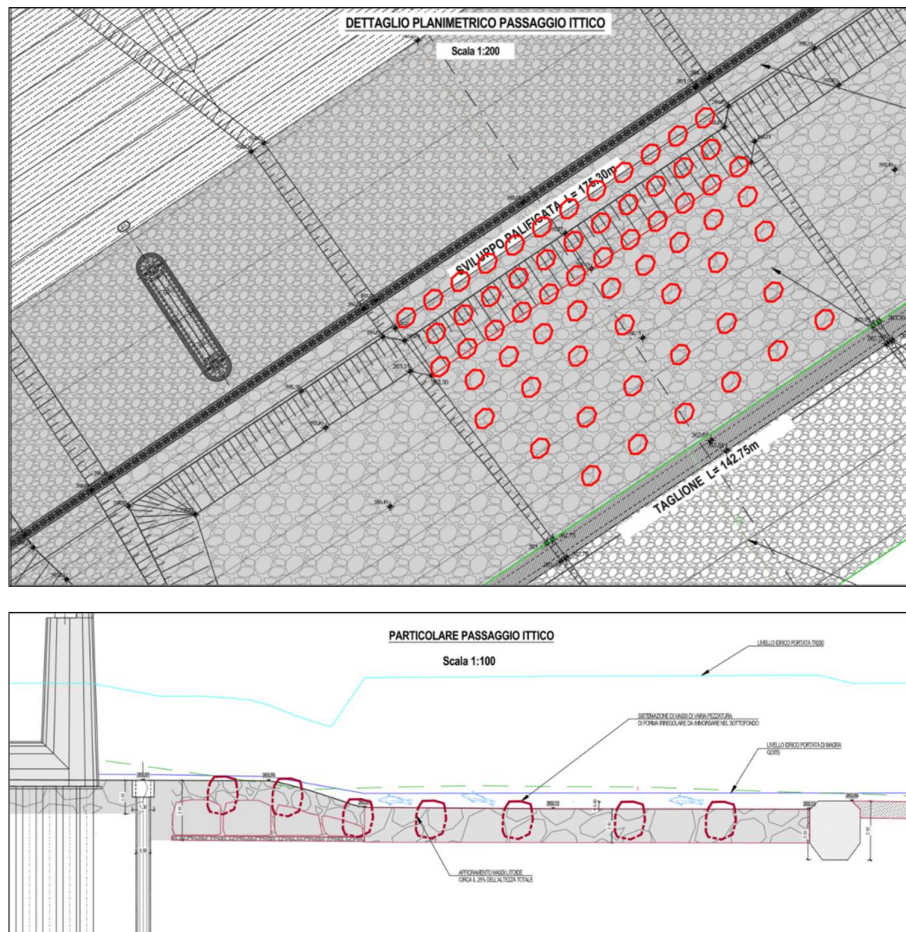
Estratto planimetrico e longitudinale dello schema di disposizione dei massi nel tratto dello scivolo.
